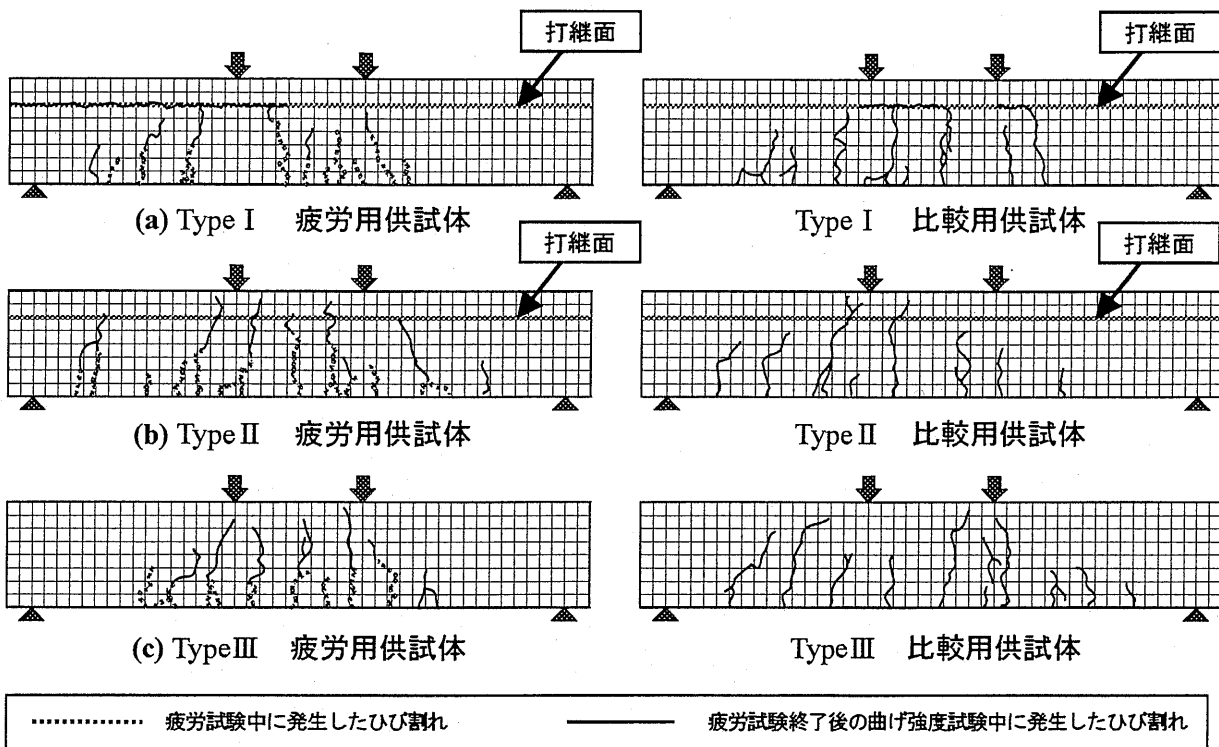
川砂利を用いた供試体のひび割れ図
